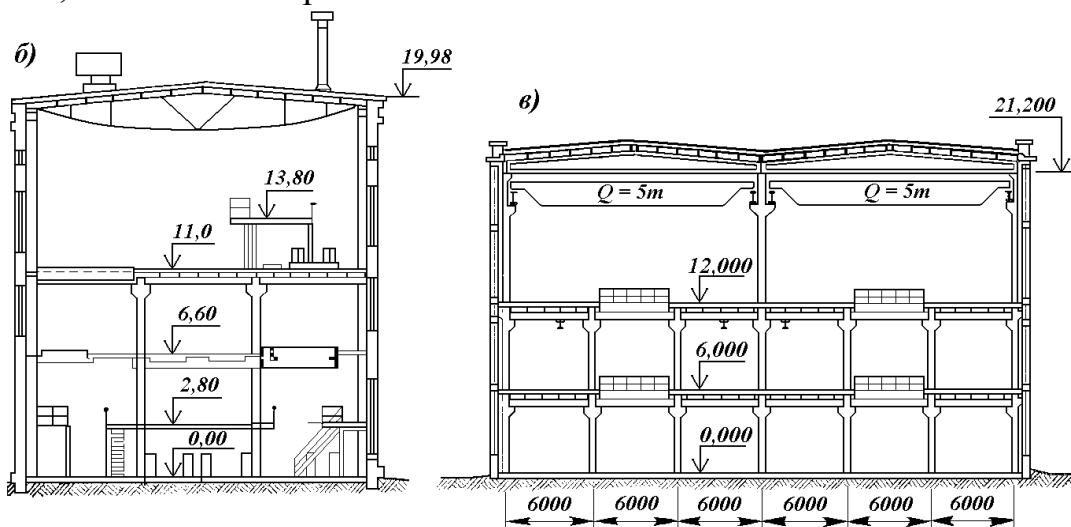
Багатоповерхові будівлі хіміко-фармацевтичної промисловості: б – без кранів; в – з мостовими кранами
